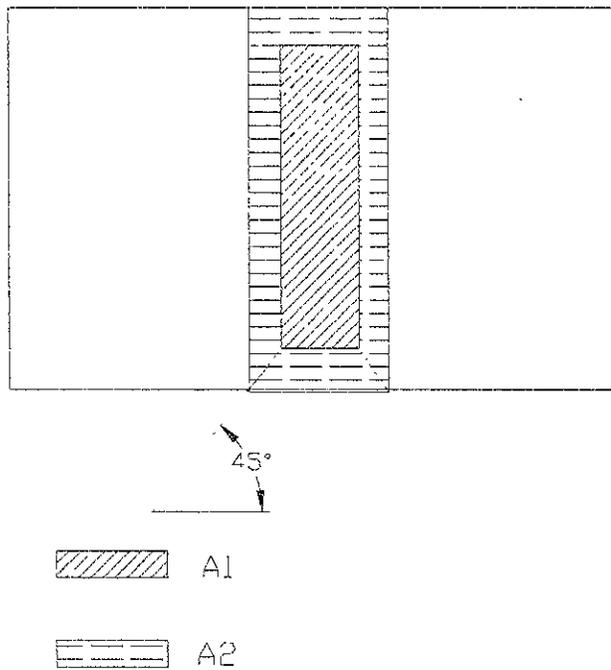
Áreas de apoyo y descarga del muro en zapata.
